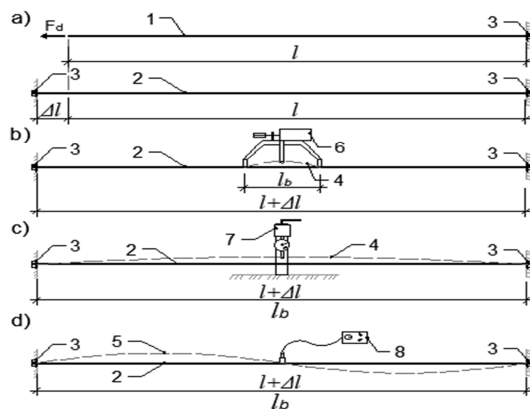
Схеми для вимірювання сили попереднього напруження арматурного елементу методом: а) по величині видовження стержня; б), в) поперечної відтяжки; частотним:
